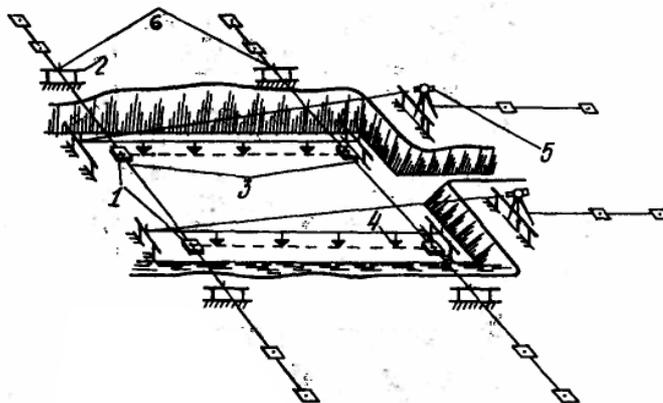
Схема разбивки сборных ленточных фундаментов:
